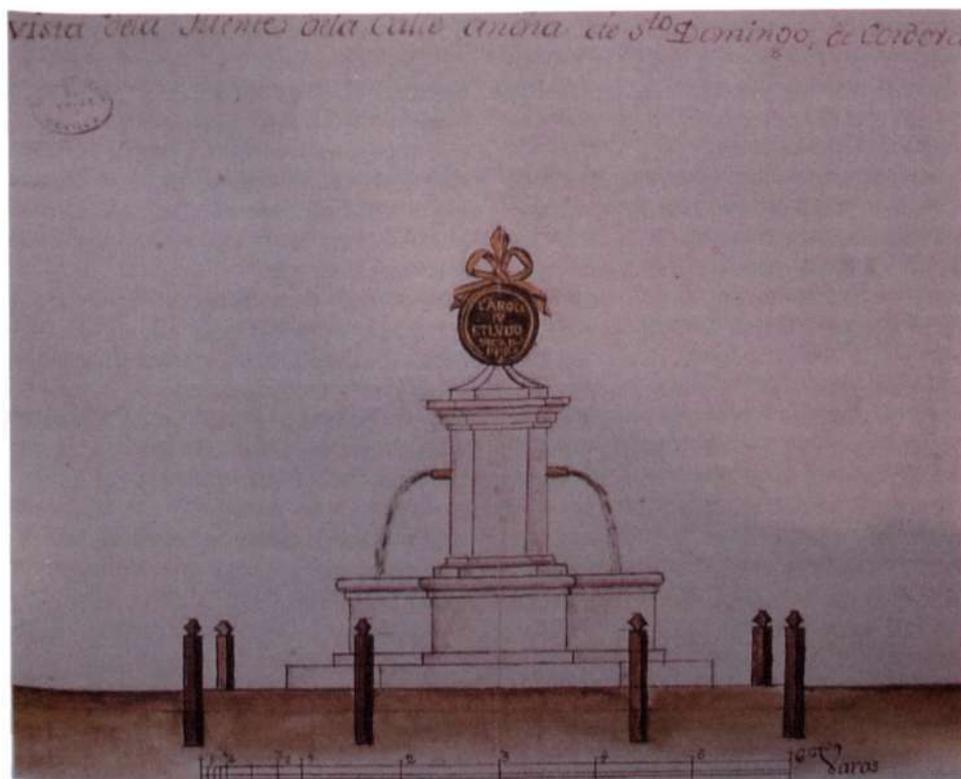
Fuente de la Calle Ancha de Santo Domingo construida en 1791.
